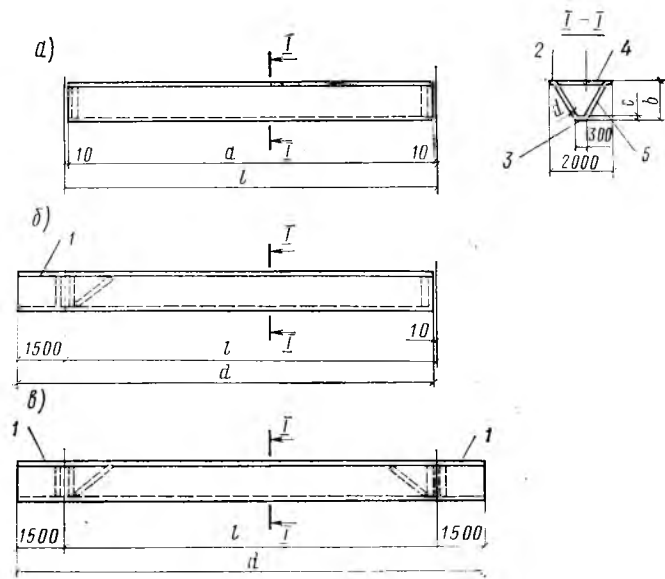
Схемы унифицированных складчатых конструкций из армоцемента и из железобетонных сборных элементов (типовой проект серии 1.266.1-3)
